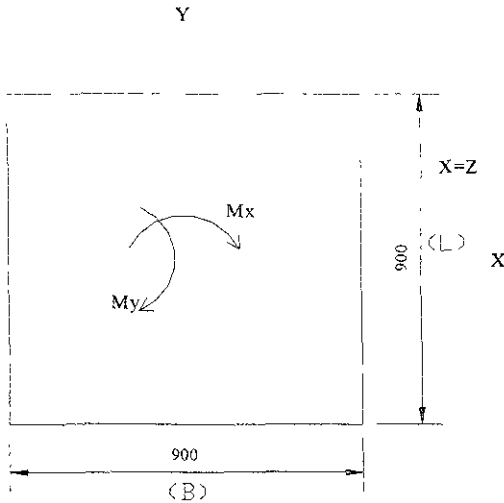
Planta de la sección de la zapata y los momentos que ejercen sobre ella
